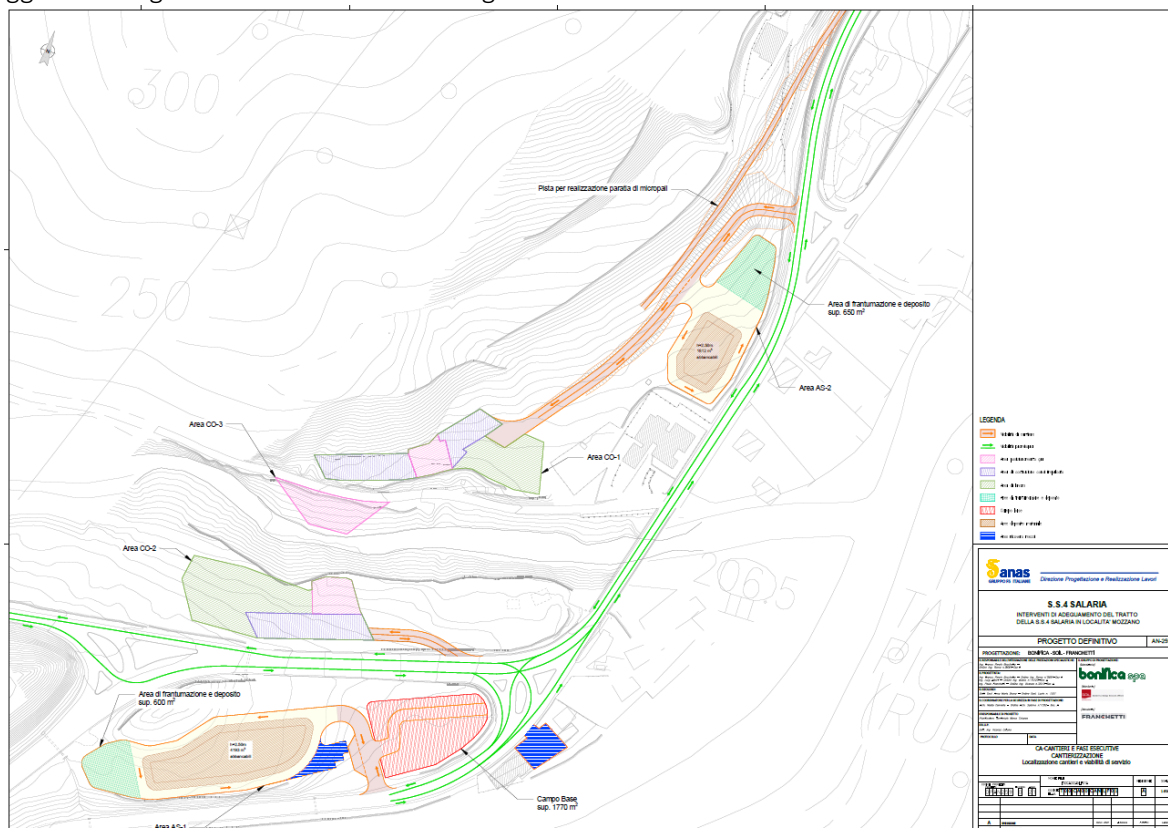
Stralcio planimetrico con individuazione delle aree di frantumazione e deposito
